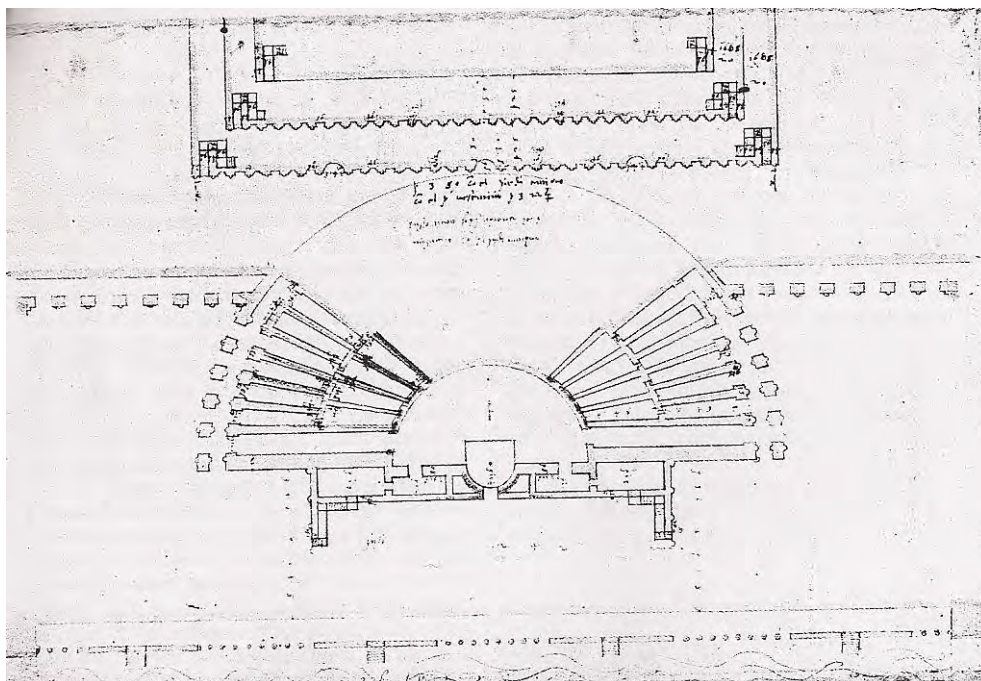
Andrea Palladio, Pianta del teatro romano di Verona, Londra, R.I.B.A
